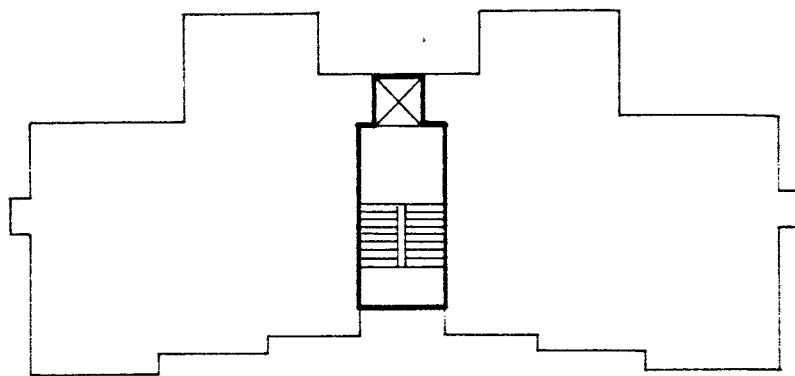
ÁREA DE CIRCULAÇÕES VERTICAL E HORIZONTAL NO PAVIMENTO TIPO, DOS PROJETOS COMPONENTES DA AMOSTRA
